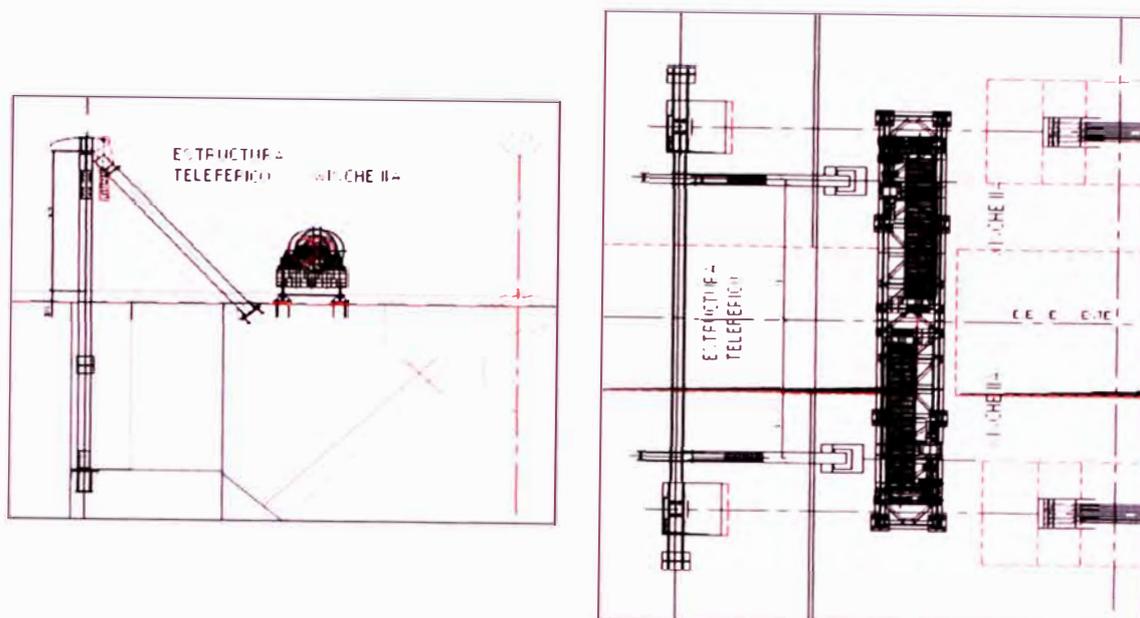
ESQUEMA DE ESTRUCTURA TELEFÉRICO CANAL
